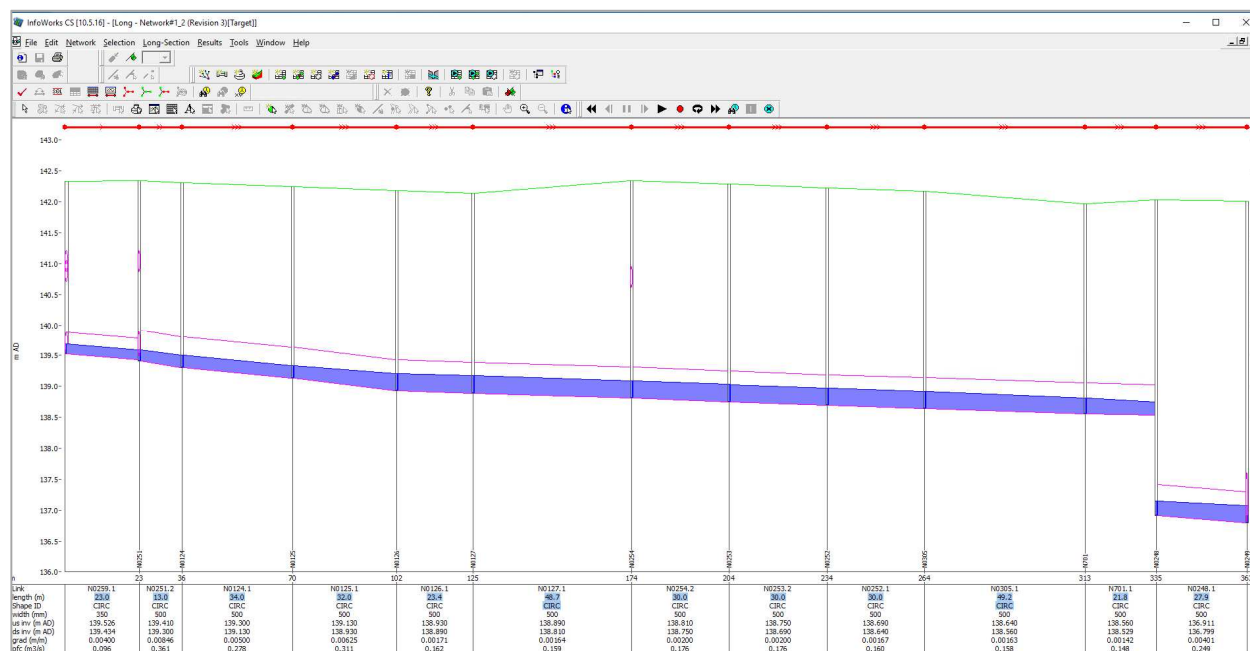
Profilo longitudinale tratto finale allaccio Nord
